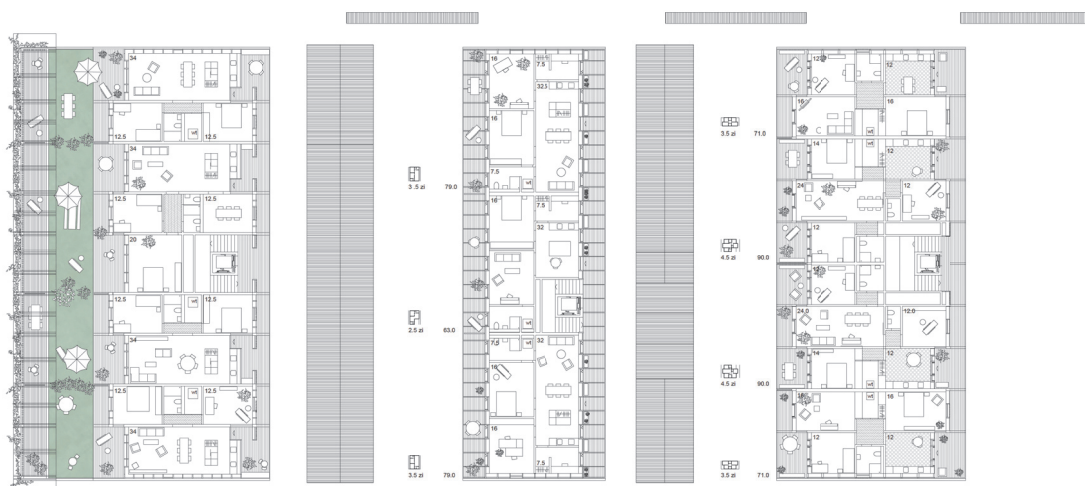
Grundrisse Regelgeschoss, Rolf Mühlethaler Architekt / w+s Landschaftsarchitekten, März 2021
